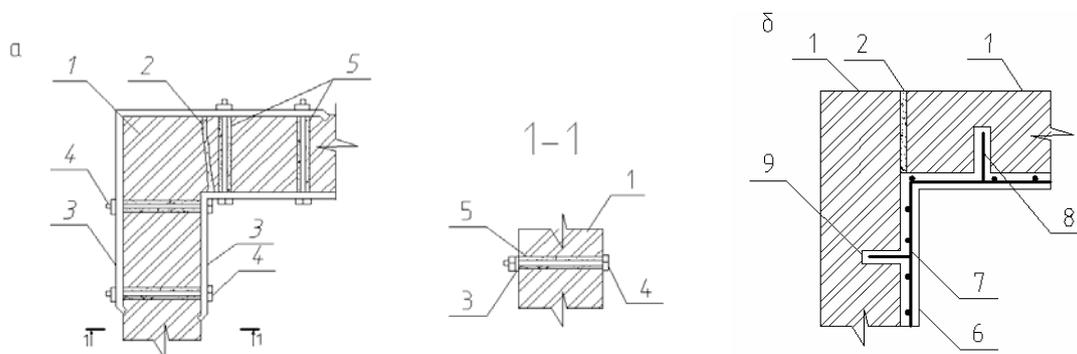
Усиление угловых наружных стен: а – металлическими накладками; б – железобетонным или штукатурным наращиванием; 1 – наружные угловые стены; 2 – трещина в стыке стен (заполнить раствором); 3 – двусторонние металлические накладки из полосы через 500 мм по высоте; 4 – стяжные болты; 5 – отверстия, просверленные в стене; 6 – штукатурная или железобетонная обойма; 7 – арматурная сетка; 8 – анкеры из арматуры периодического профиля диаметром 10 мм через 600 – 800 мм по горизонтали и вертикали, установленные на растворе; 9 – отверстия, просверленные в стене на глубину не менее 100 мм
